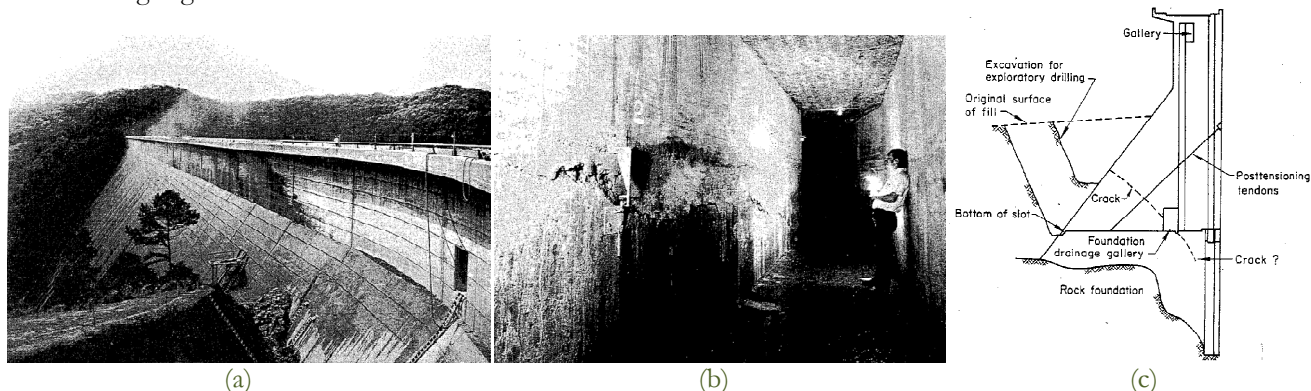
Fessurazione della diga di Fontana (figure e schemi tratti da [4]): (a) Vista aerea della diga; (b) Vista del punto di emersione della fessura nella galleria di ispezione; (c) Sezione trasversale di un elemento monolitico fessurato.
